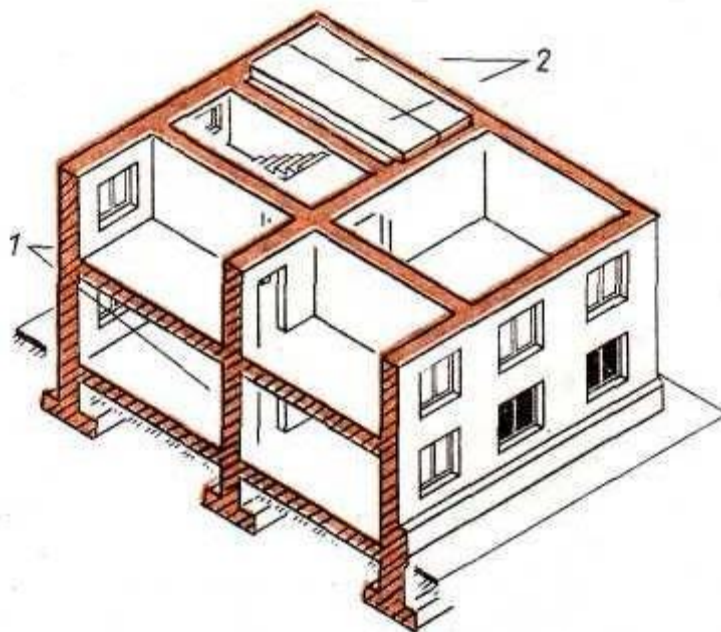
Схема безкаркасної будівлі з позначенням несучих стін і перекриттів:
